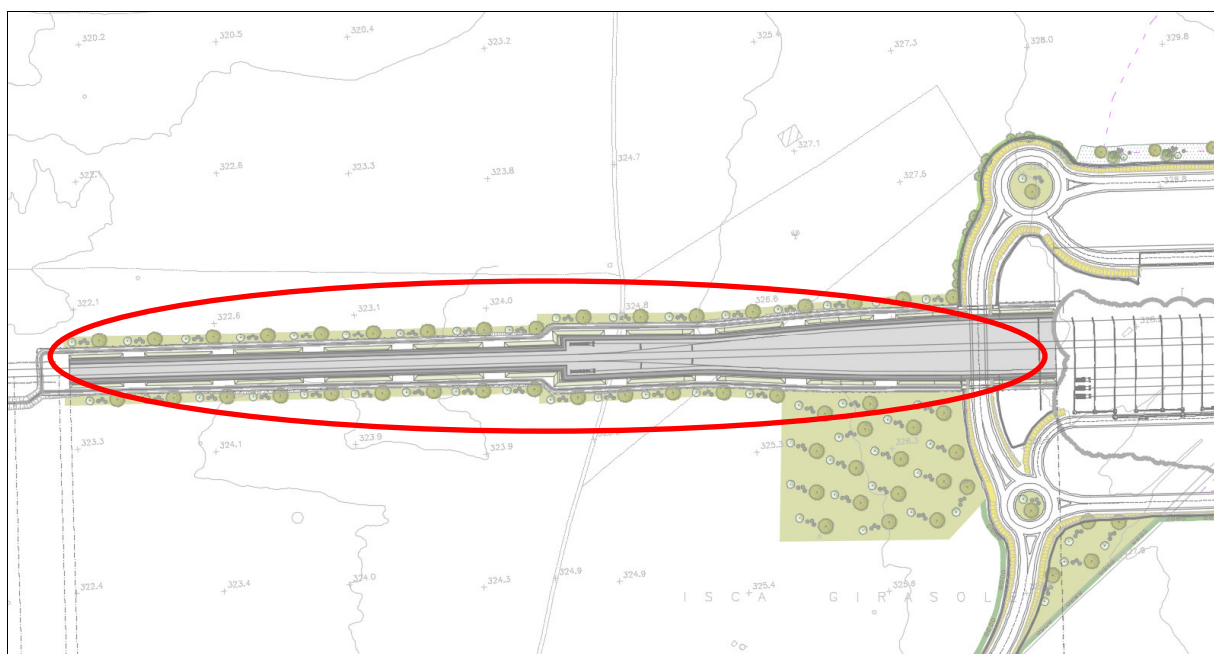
Stralcio planimetrico con l'individuazione delle opere a verde di mitigazione
